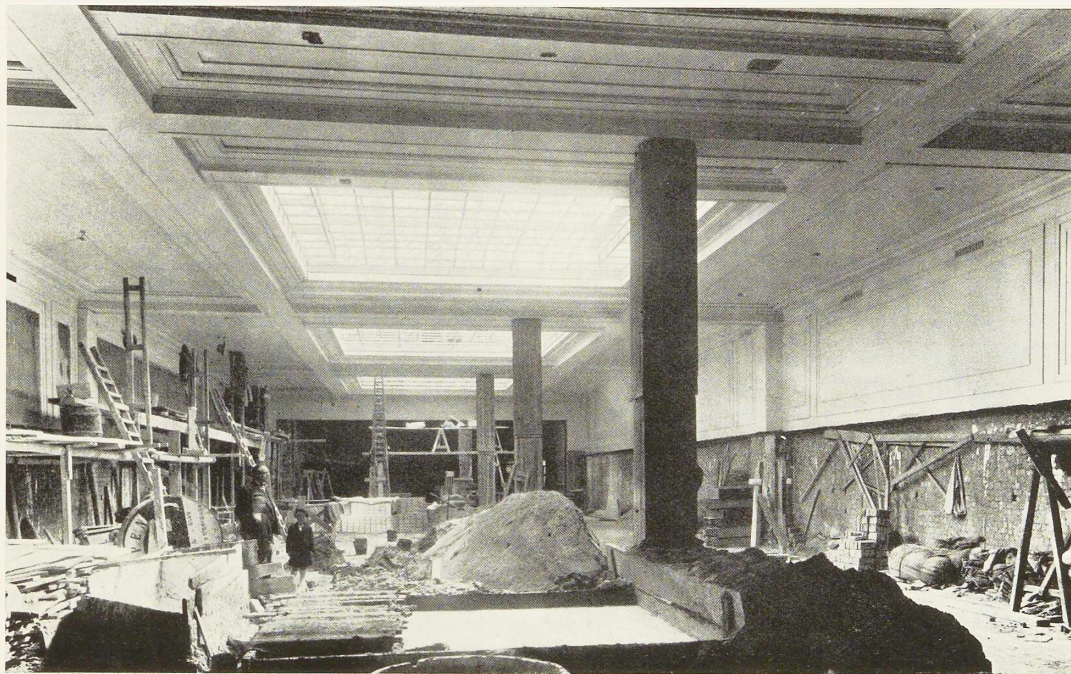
Une vue du rez-de-chaussée du magasin « Priba » prise pendant le placement des revêtements des murs et du plafond.
